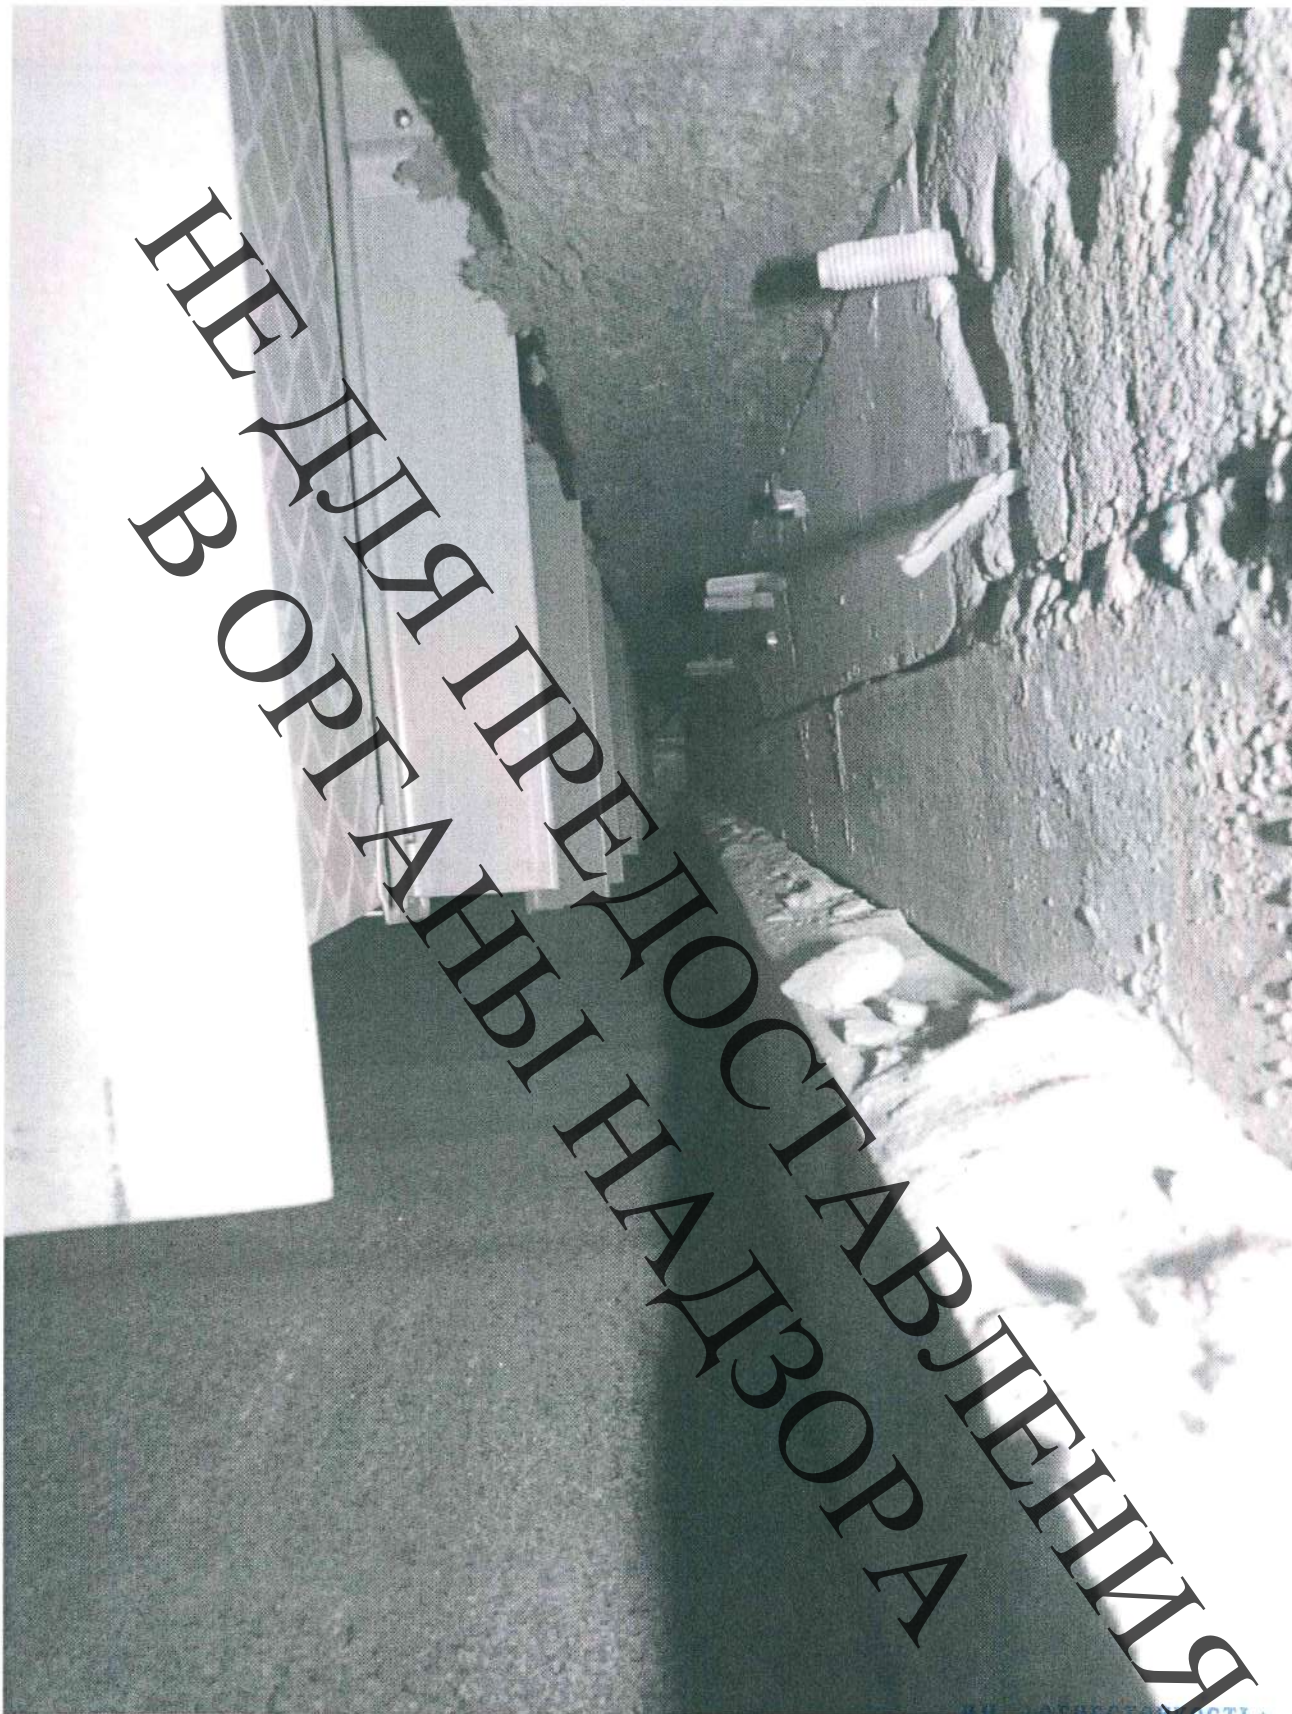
Образец перед испытанием (нижняя часть вентилируемый зазор)
